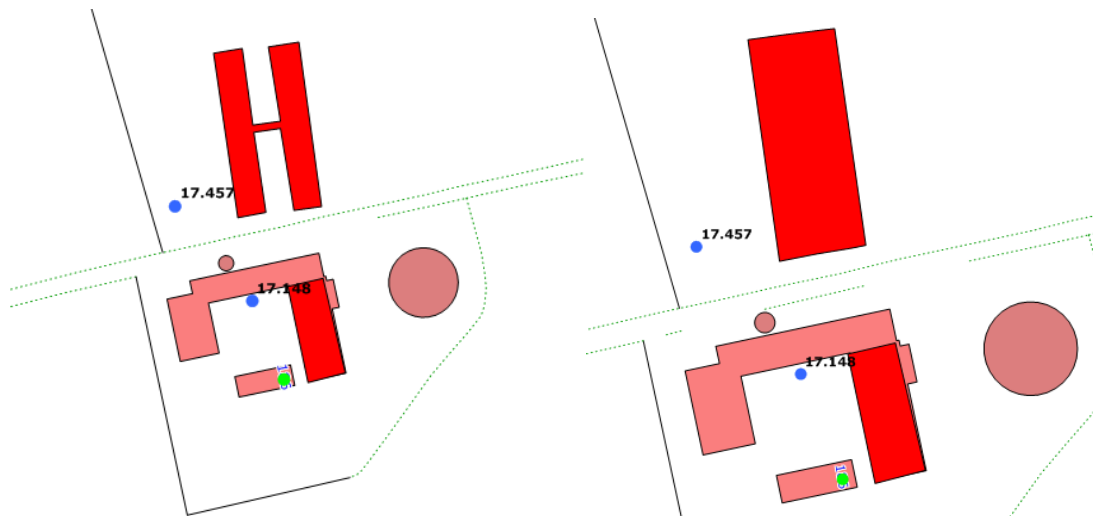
Situationsplan over Kjølsskevej 186. Rundbuehal-scenariet.
